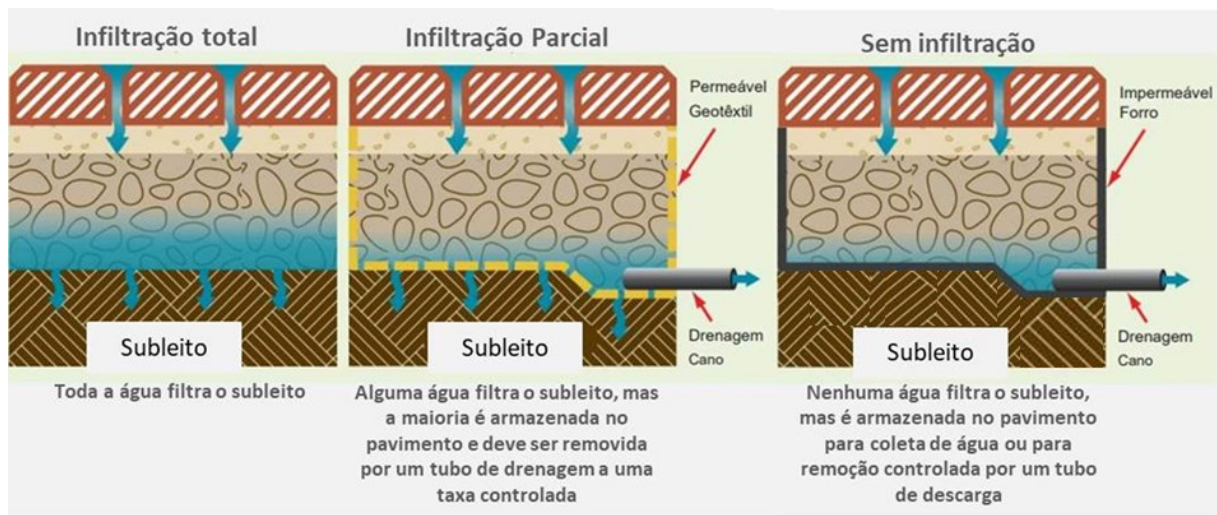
Tipos de infiltração para sistema de pavimento permeável
